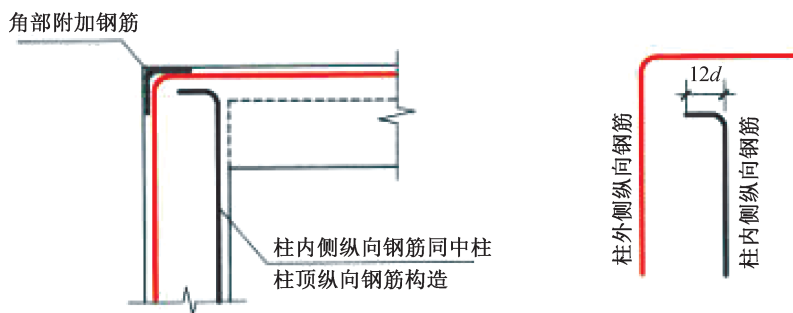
梁宽范围内柱外侧纵向钢筋弯入梁内作梁筋构造
